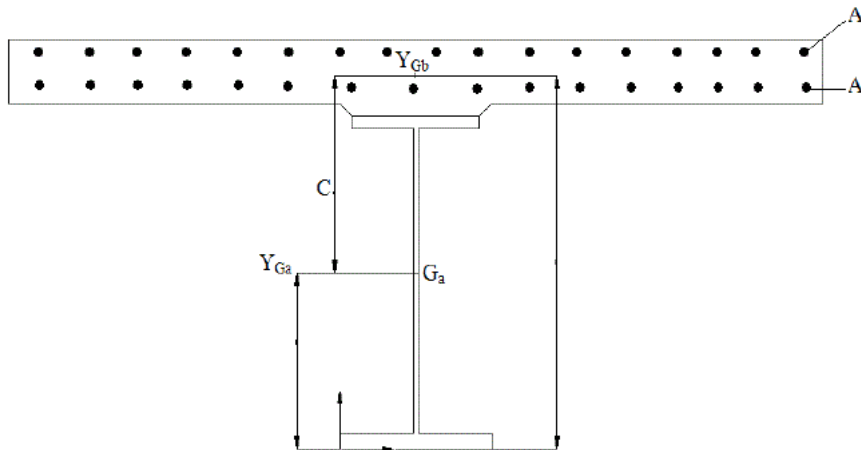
Centre de gravité de la section d'acier avec armatures
